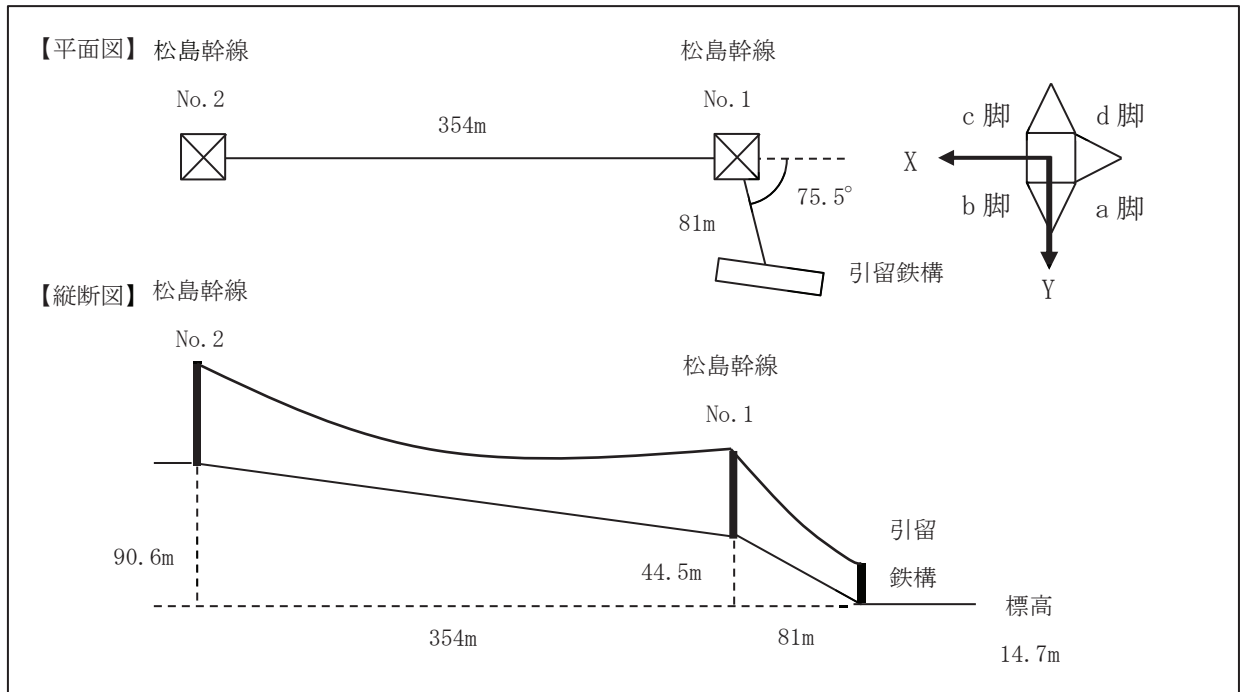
連成モデル (平面図, 縦断面図)
